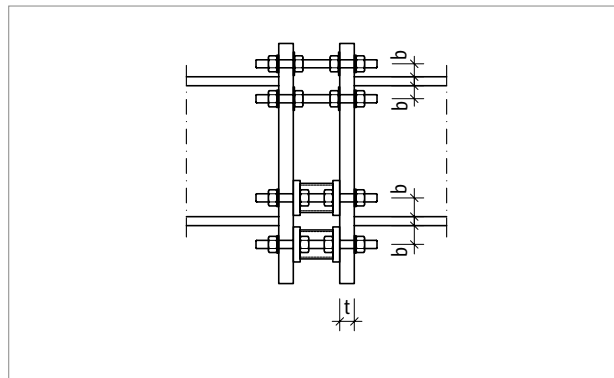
Platine frontale T type S : tableau des valeurs géométriques d'entrée ; vue en coupe
